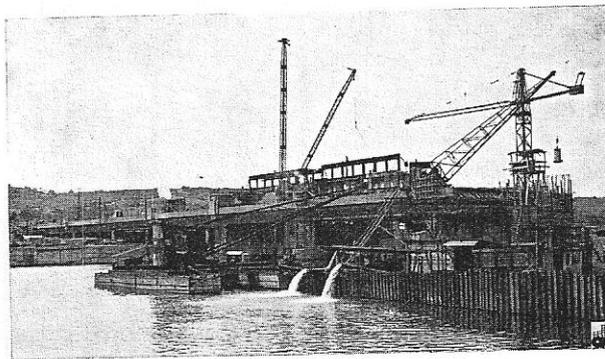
Vue générale du barrage de Ramet-Ivoz en cours de construction. On remarque à droite le batardeau en palplanches métalliques des pertuis en construction.
